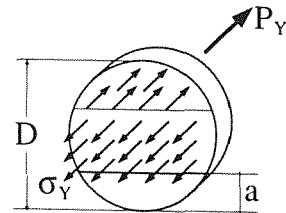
Agotamiento plástico de una armadura fisurada.
